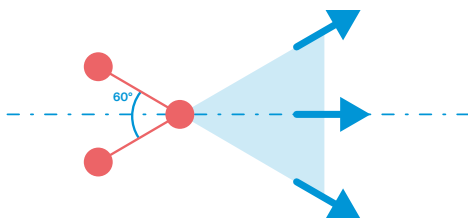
Dreieckverankerung mit drei Stäben (Grundriss)
